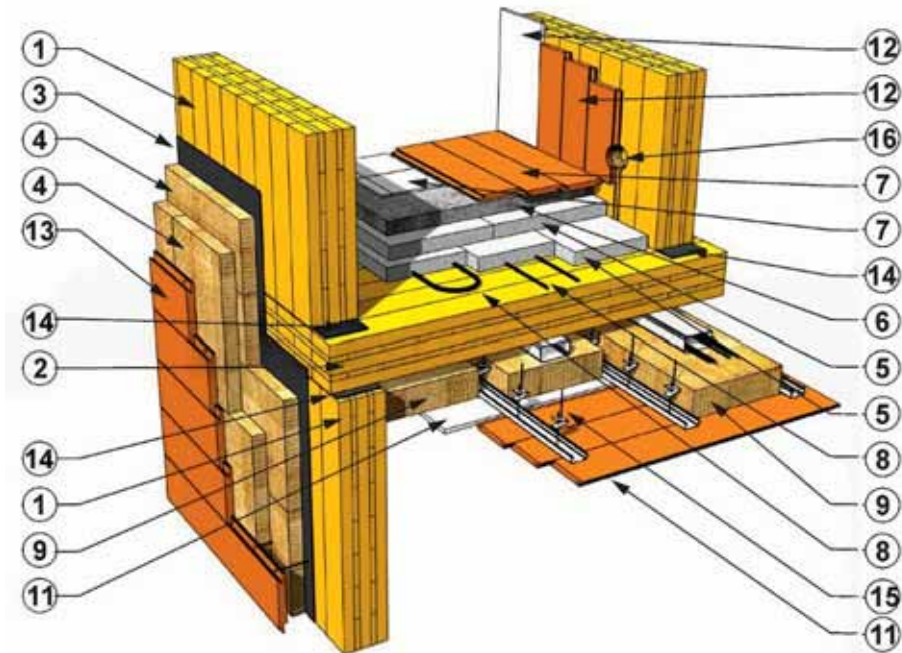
Конструктивные схемы многоэтажного здания: 1. Несущая стена из CLT или MHM панелей толщиной 160 мм.; 2. Перекрытия из CLT или MHM панелей толщиной 160 мм.; 3. Пароизоляционная мембрана; 4. Теплоизоляционные плиты 2 x 50 мм, плотностью 100 кг/м³; 5. Пеноплекс 2 x 50 мм, плотностью 20–40 кг/м³; 6. Стяжка из легкого бетона толщиной 60 мм; 7. Напольное покрытие; 8. Сети; 9. Шумоизоляционные плиты 100 мм, плотностью 40 кг/м³; 10. Пароизоляционная мембрана; 11. Чистовой потолок; 12. Отделка интерьеров; 13. Фасадный материал; 14. Шумоизоляционный демпфер; 15. Подсистема чистового потолка; 16. Штробы
